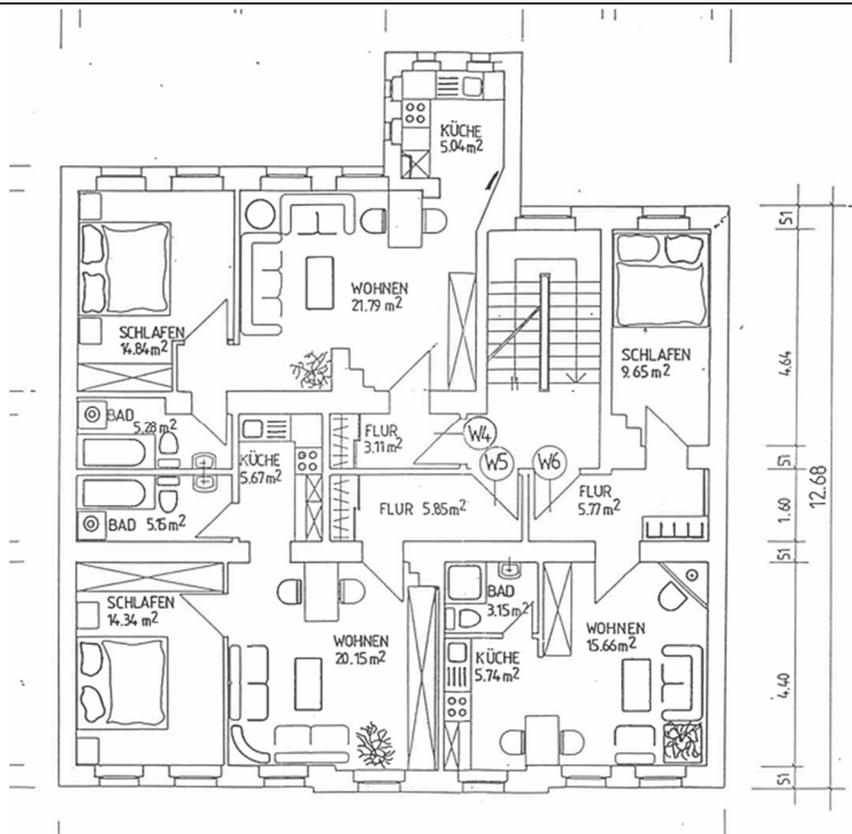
Grundriss 2. Obergeschoss
